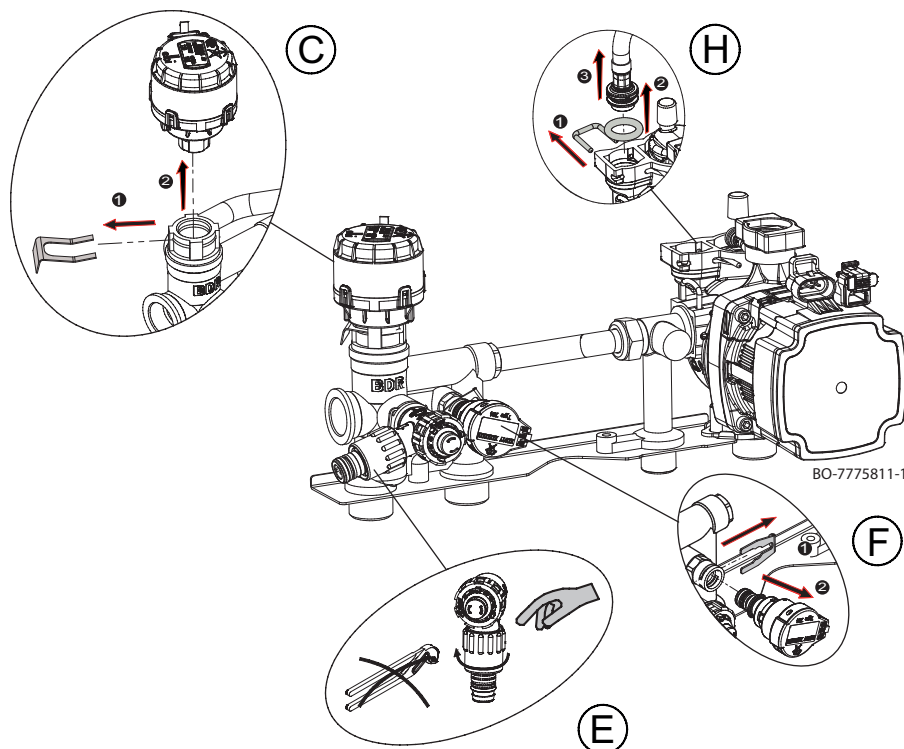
Pièces pour groupe hydraulique de chaudière Chauffage seulement pré-équipée pour le raccordement à un ballon ECS
